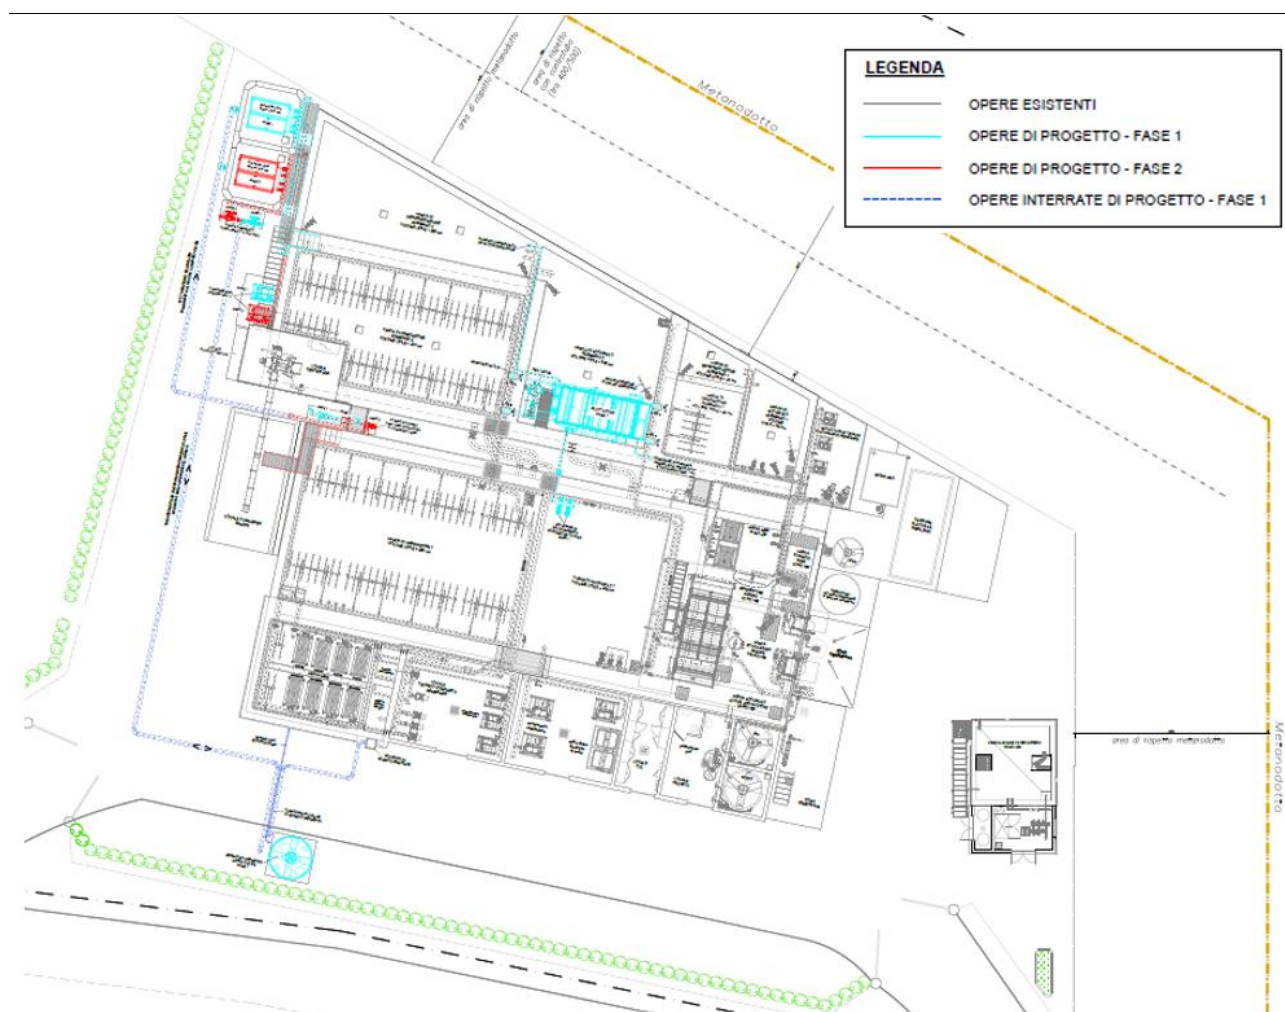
Planimetria depuratore con le opere da realizzare (v. All. 2.6)
